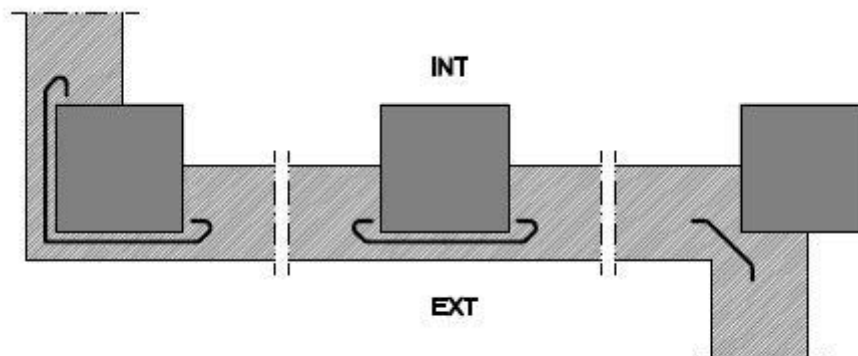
Ejemplo de encuentro de la fachada con los pilares
